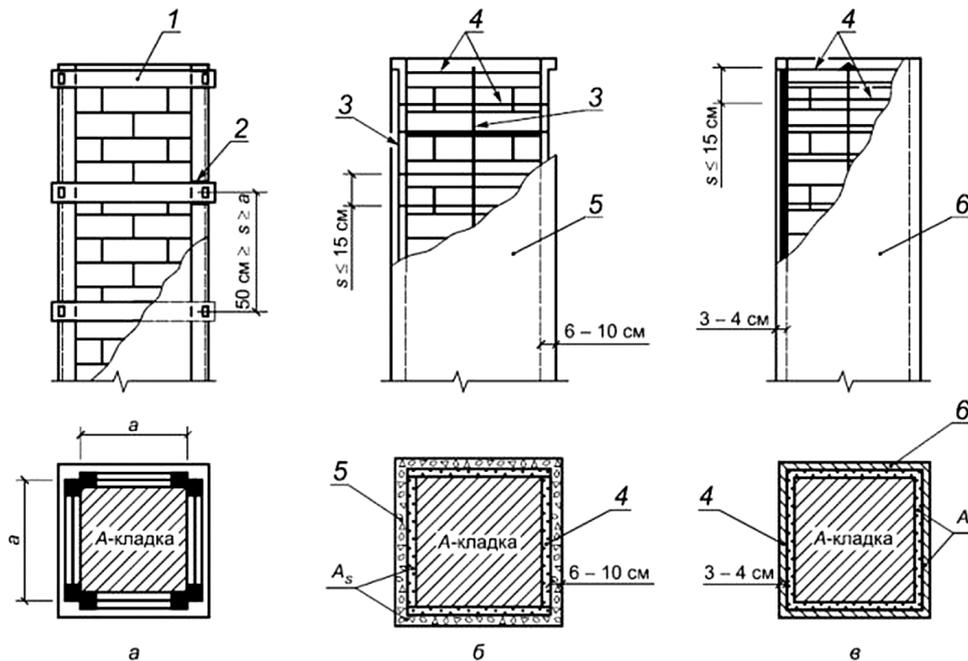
Поперечные сечения вариантов усиления простенка: а) обойма металлическая, б) обойма железобетонная; в) обойма из композитного материала; 1 — планки из стали; 2 — прокатные уголки из стали; 3 — продольные стержни из арматурной стали; 4 — поперечные стержни из стали и композитного материала; 5 — бетон; 6 — штукатурка
